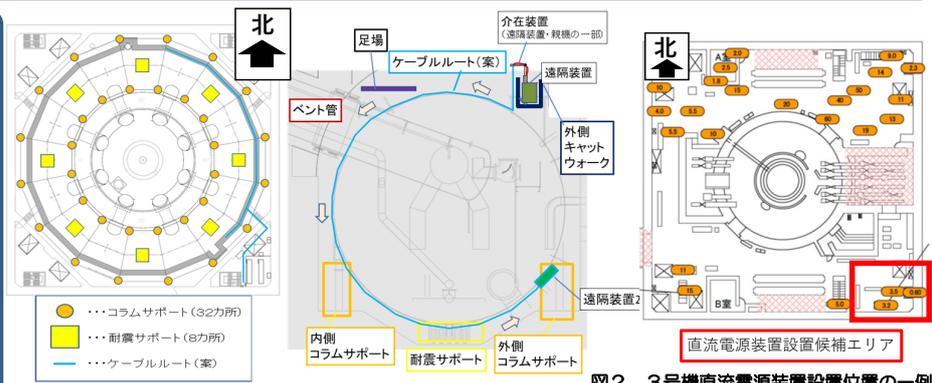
3号機電極・ケーブル設置ルートの一例 (左:平面図, 右:断面図)
